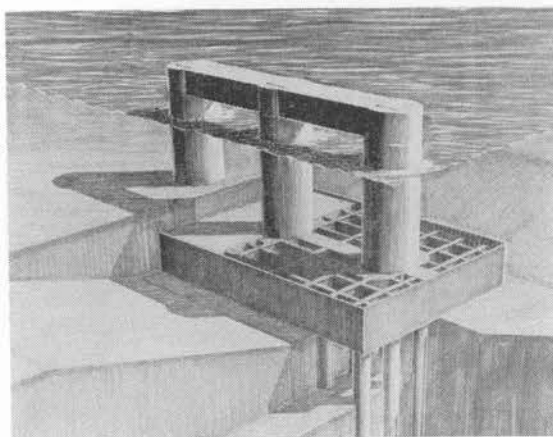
鋼橋脚一体の鉄骨フーチングの予想図
